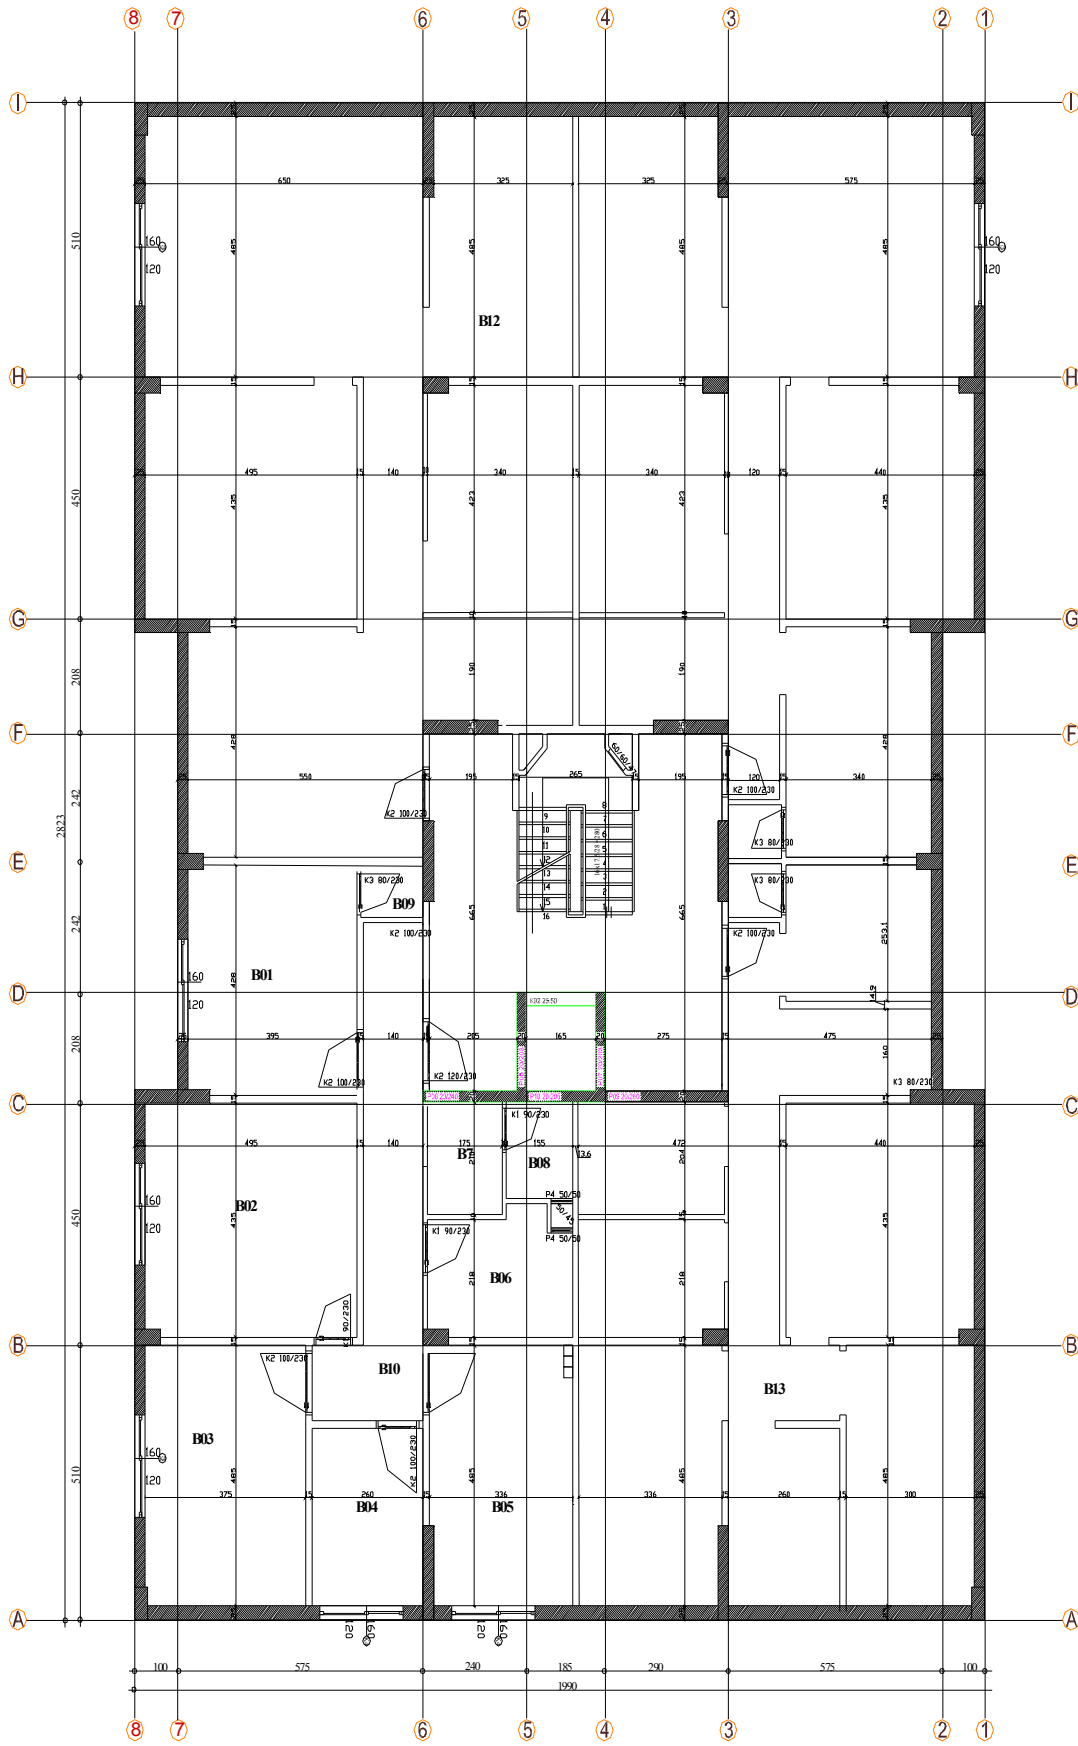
Tünel kalıp sistem bodrum kat planı
